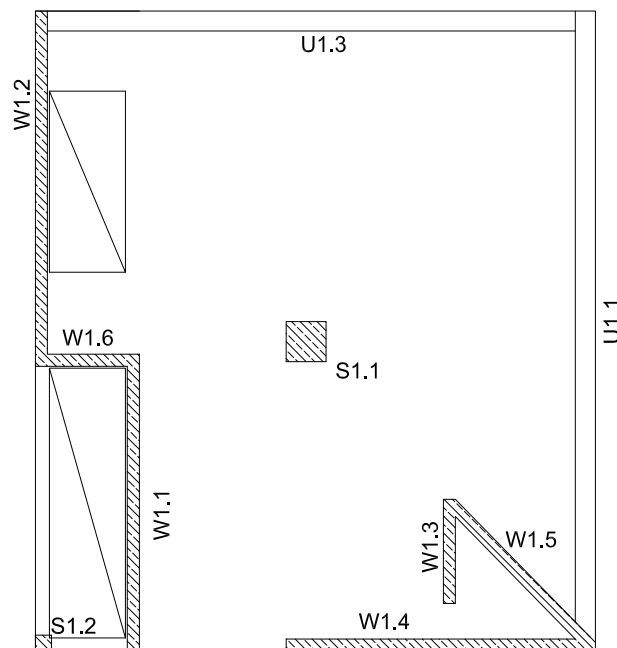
Bürohaus X: Grundriss Erdgeschoss [Lie09]
